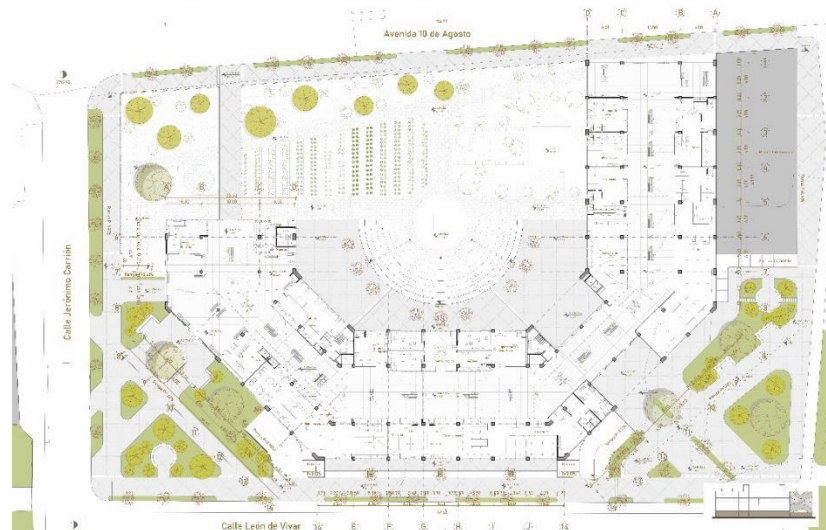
Planta Baja, pasaje comercial *Fuente: Elaboración Propia
